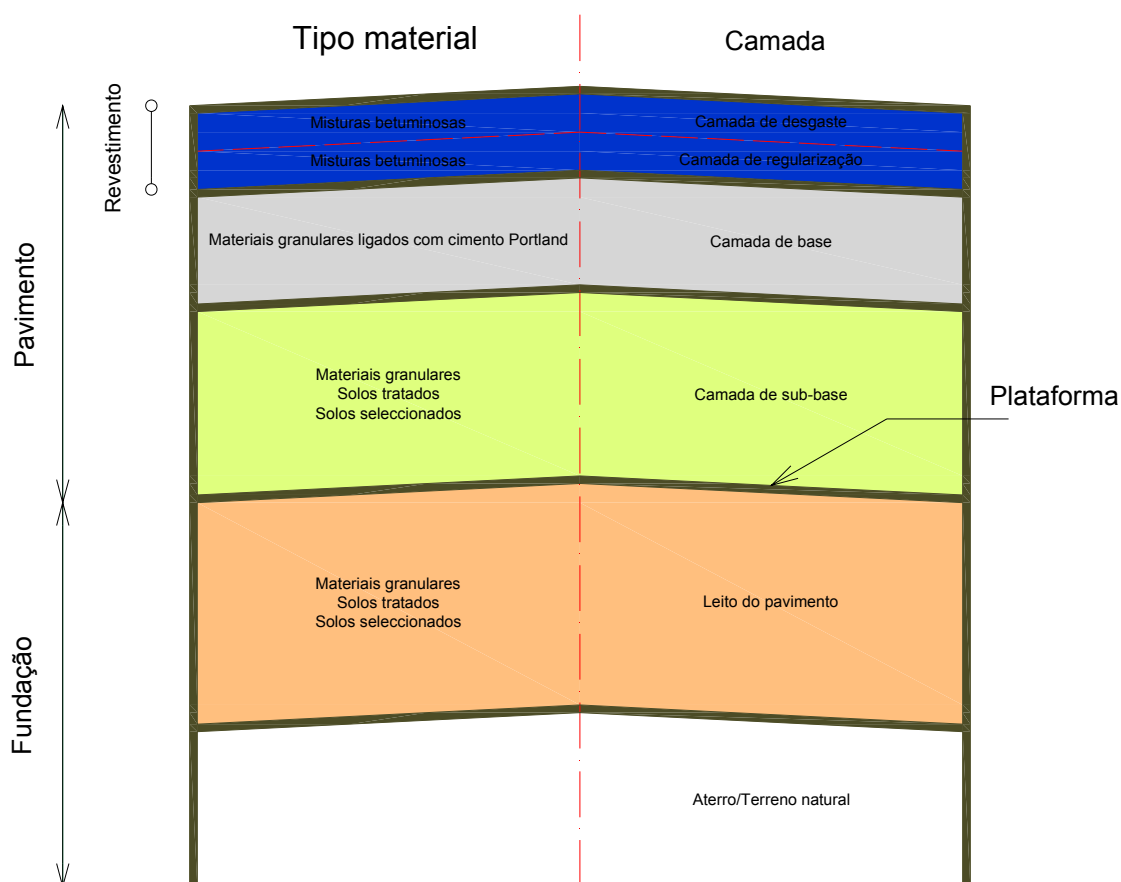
Estrutura tipo de pavimento semi-rígido
